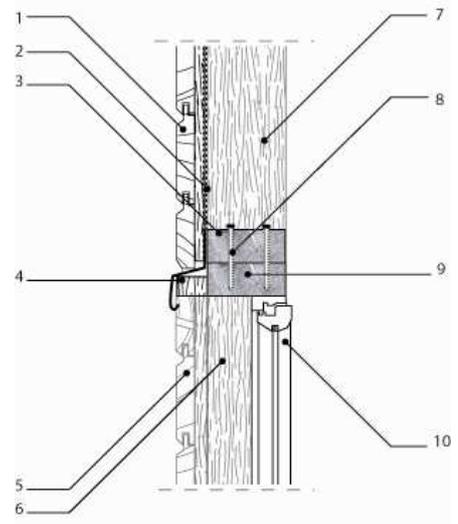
Schémas de principe des encadrements de baie : coupe verticale sur linteau
